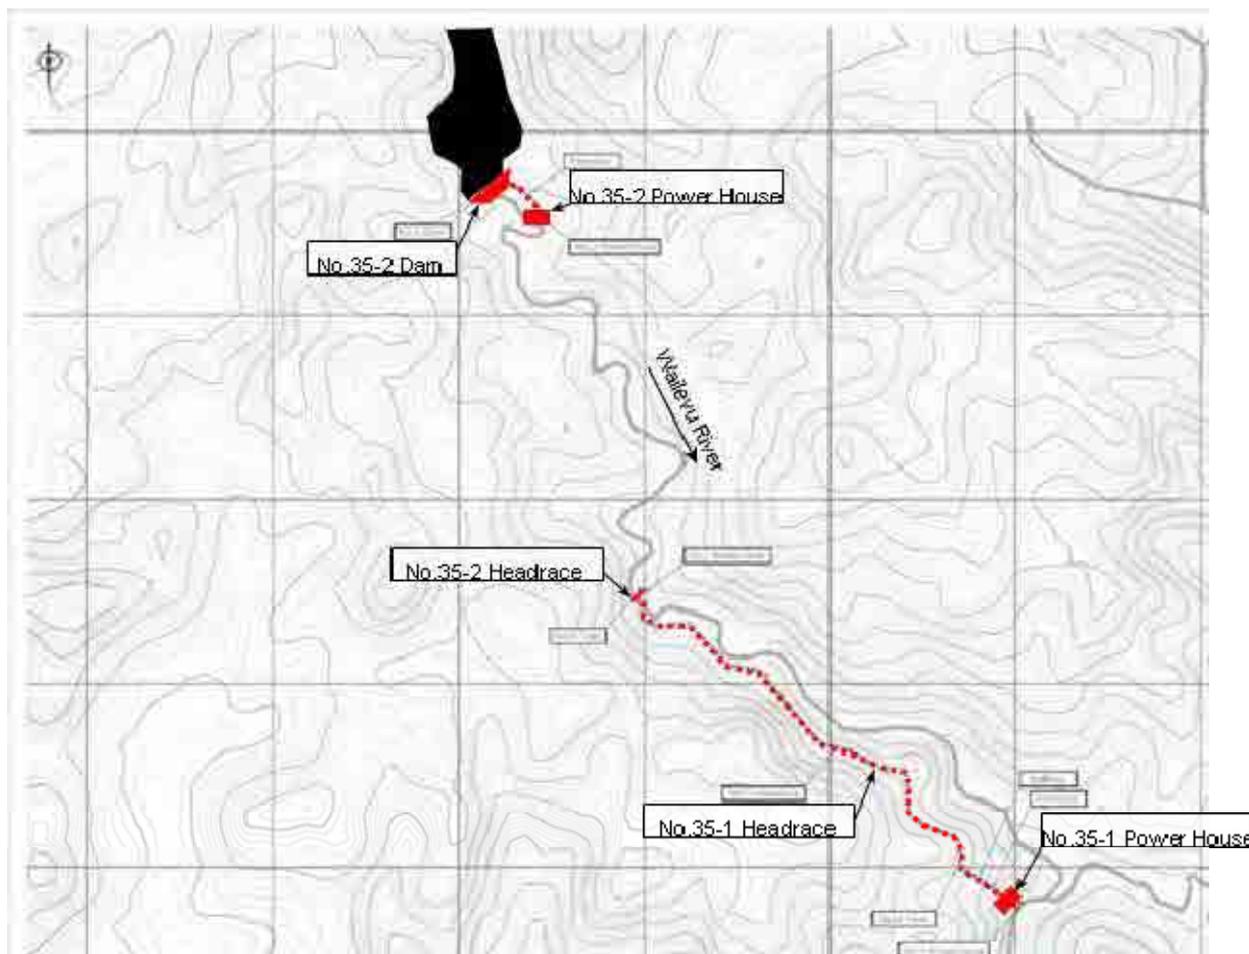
No.35 Wailevu 水力発電計画一般平面図
